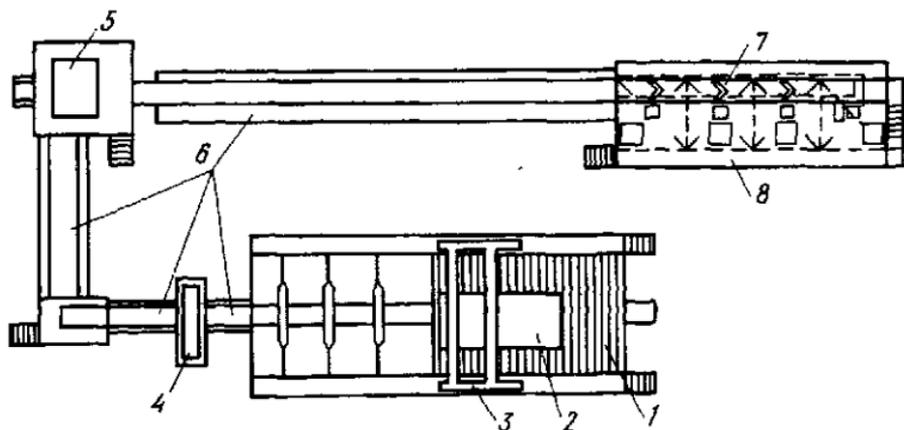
Технологическая линия по переработке некондиционного бетона и железобетона на КЖБК-2 Главмоспромстройматериалов
